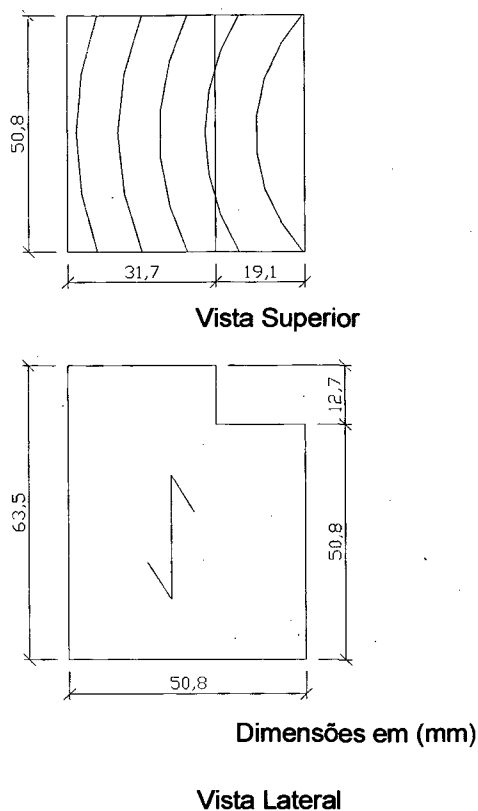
Corpo-de-prova para ensaio de cisalhamento paralelo às fibras da madeira. Fonte: ASTM D 143/83.
